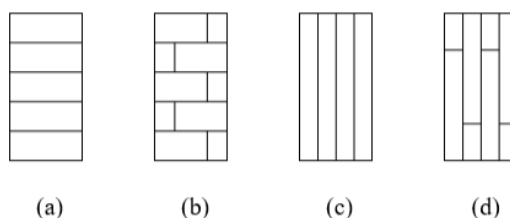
Laminação horizontal sem emendas transversais (a) e com emendas transversais (b), e laminação vertical sem emendas transversais (c) e com emendas transversais (d).
